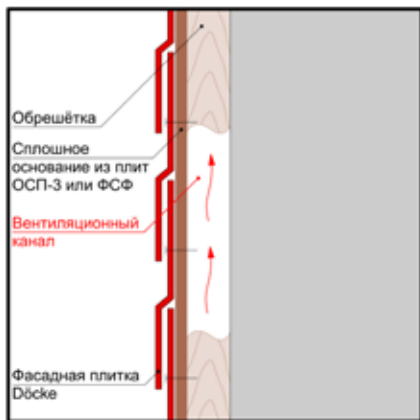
Схема вентилируемого фасада на примере фасадной плитки Döcke.
